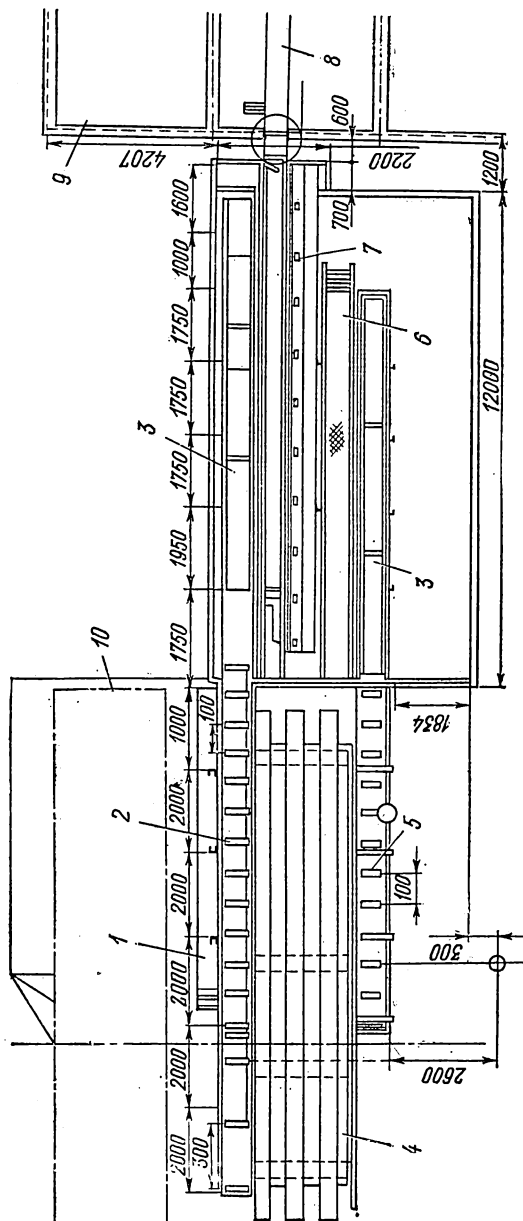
Технологическая планировка площадки для производства электромонтажных работ при продольном рас-
